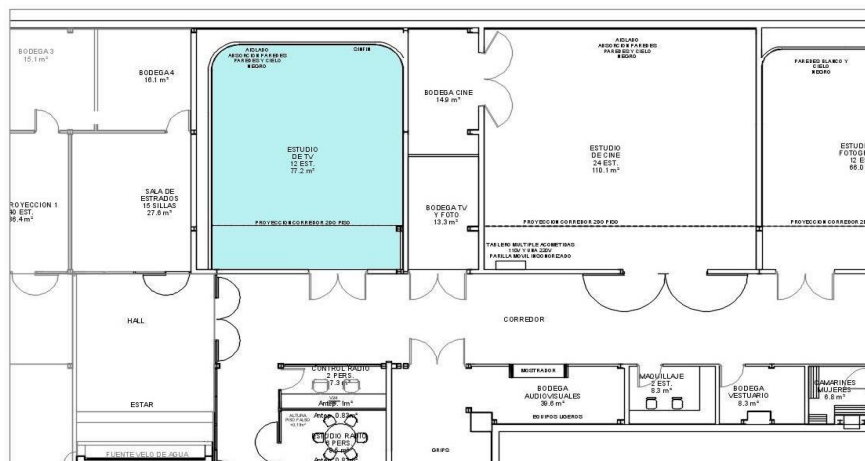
Plano arquitectónico. Estudio de Televisión en Planta Baja
